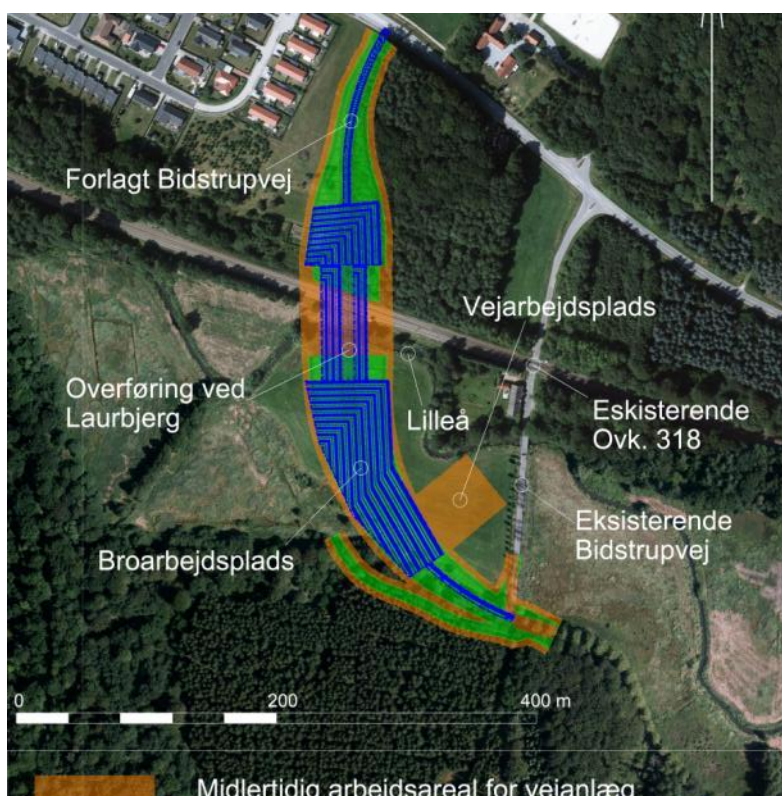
Bro 20961, Overføring ved Lerbjerg. Oversigtsplan.
